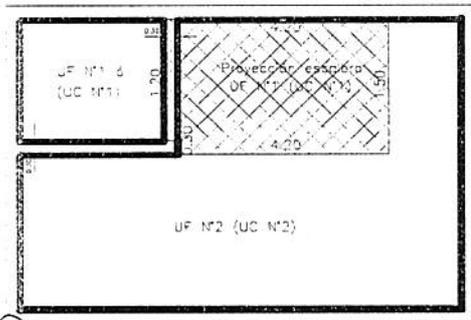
REPRESENTACIÓN EN PLANTA SÓTANO
